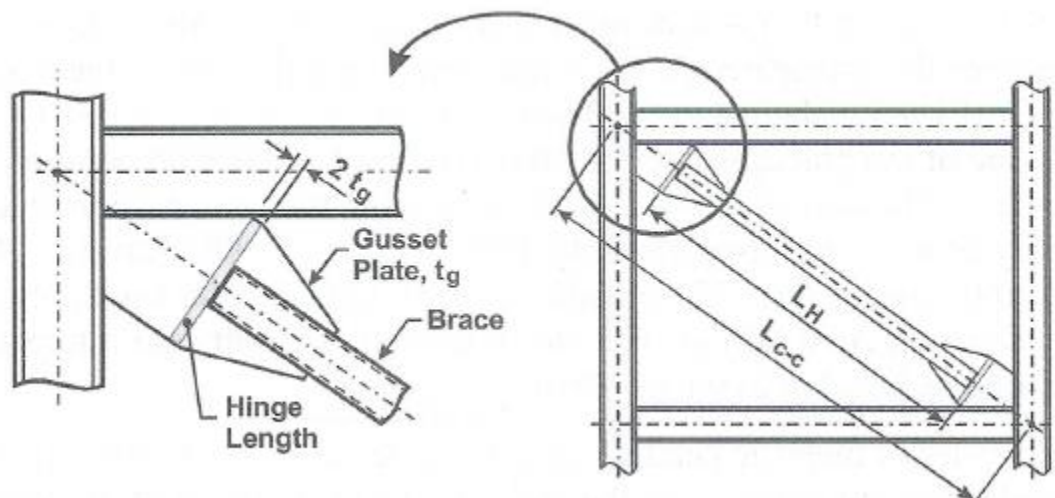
Détail de gousset pour permettre le flambement hors plan des diagonales
